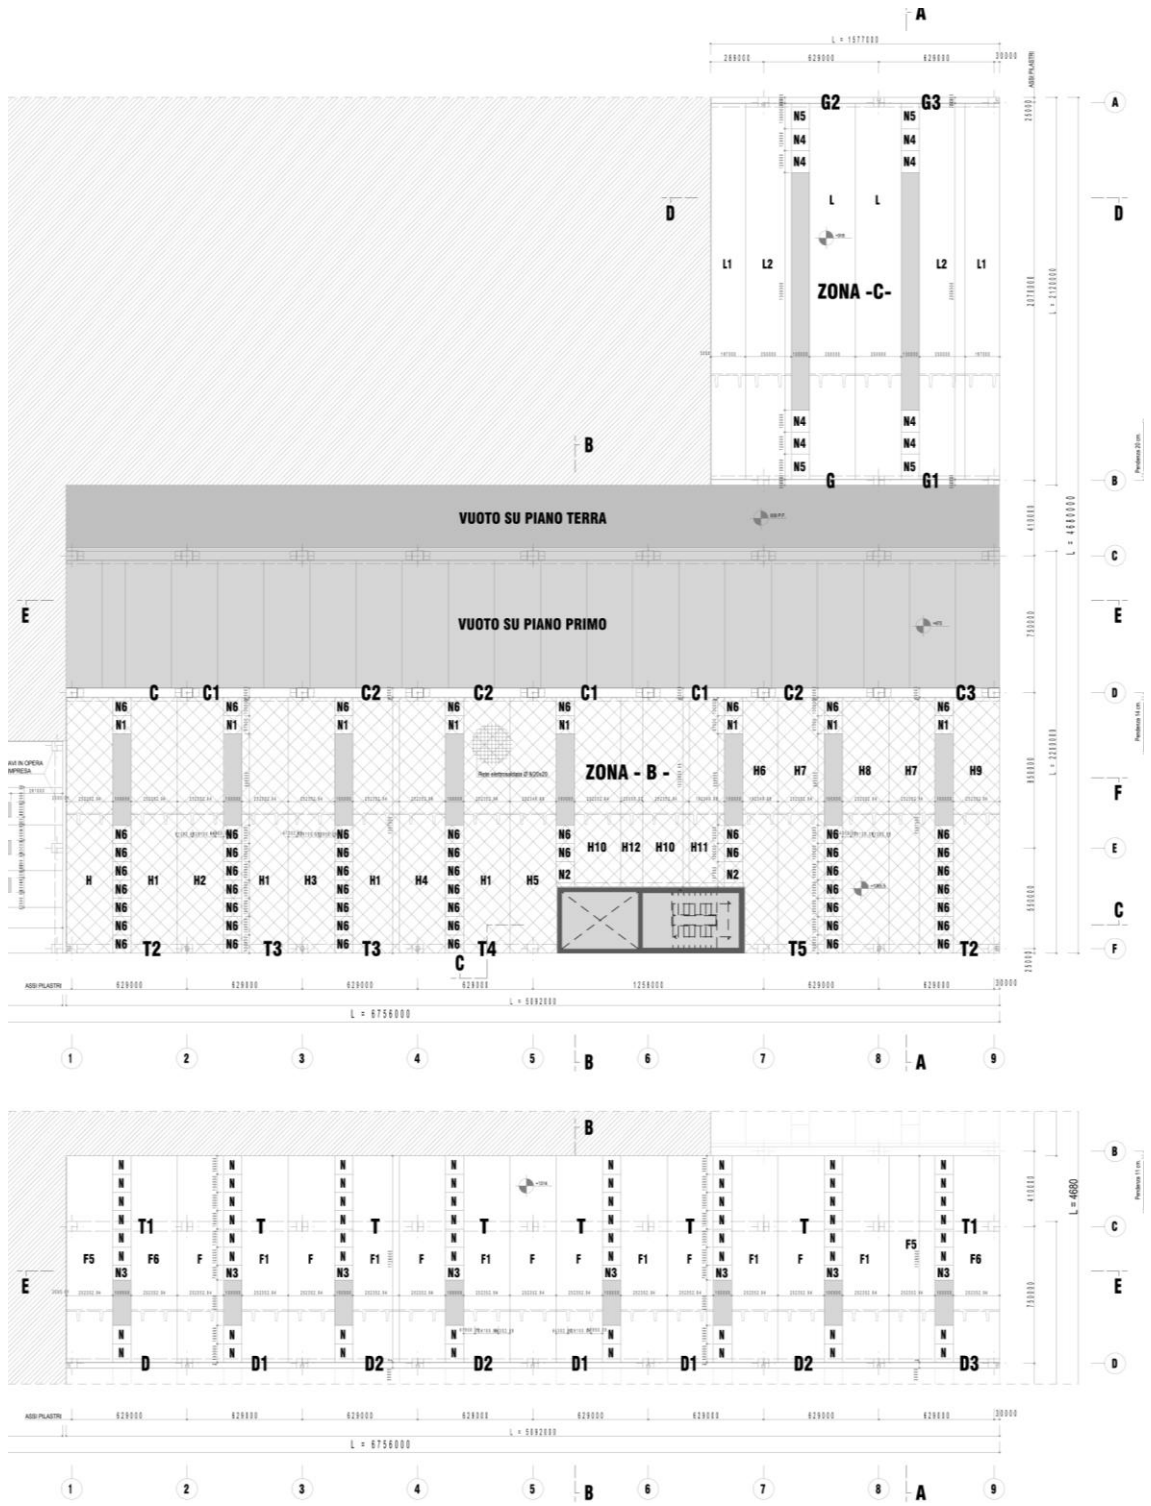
Particolare di A.2003.cap.us.T22 - Pianta copertura
